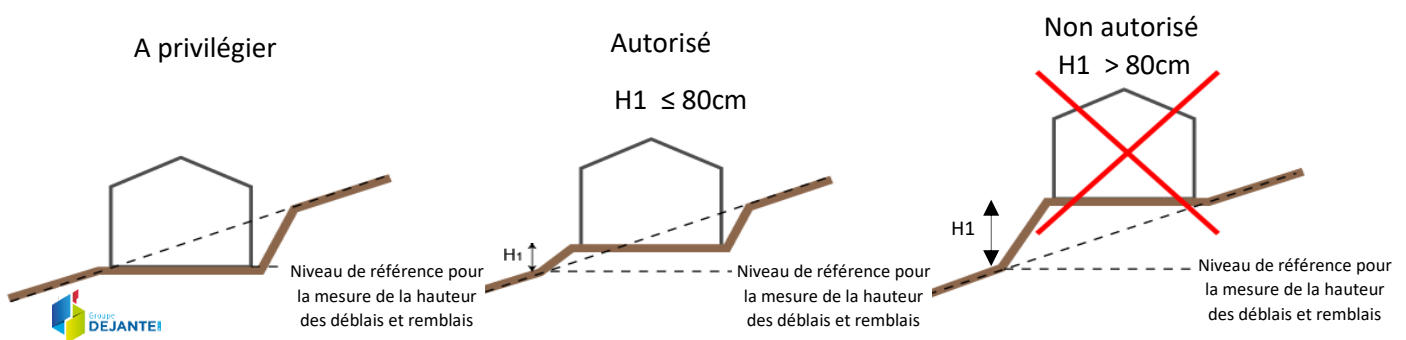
Règle générale pour l'implantation des constructions en zone Ue
